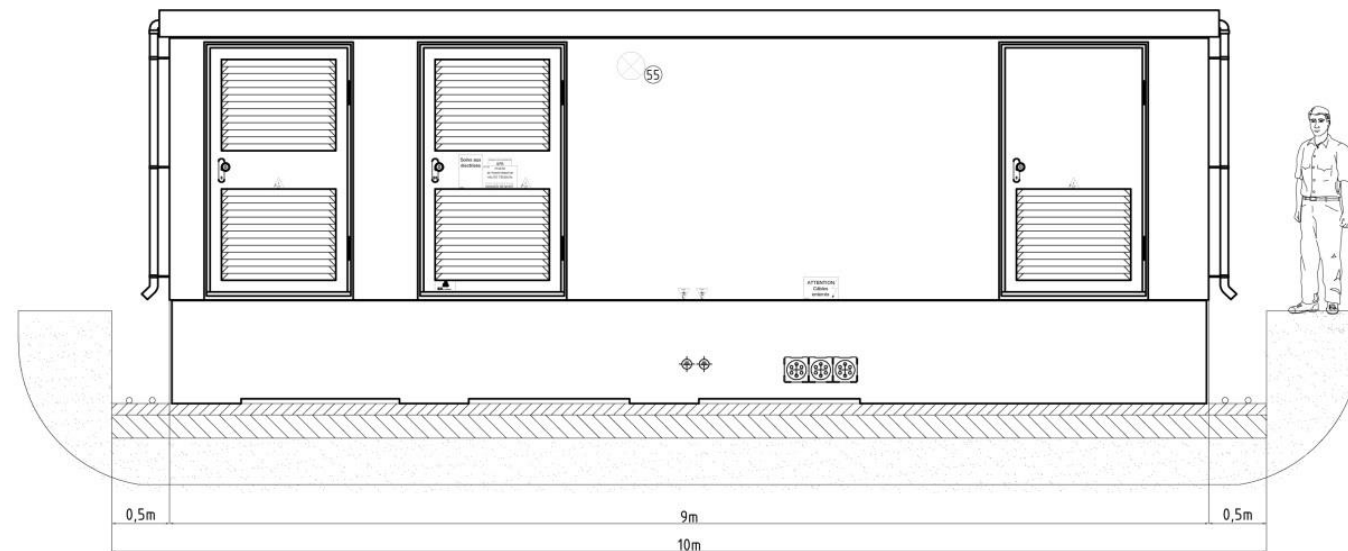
Plan de façade d'un poste de livraison (vue de face)
